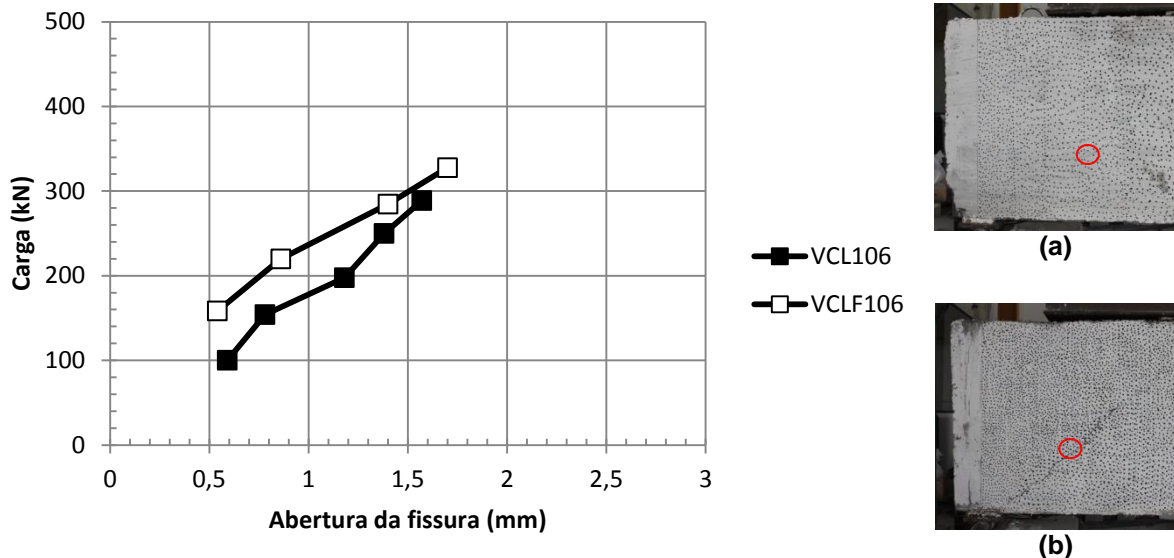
Evolução da abertura de fissuras nas vigas-parede: a) VCL106 e b) VCLF106.
